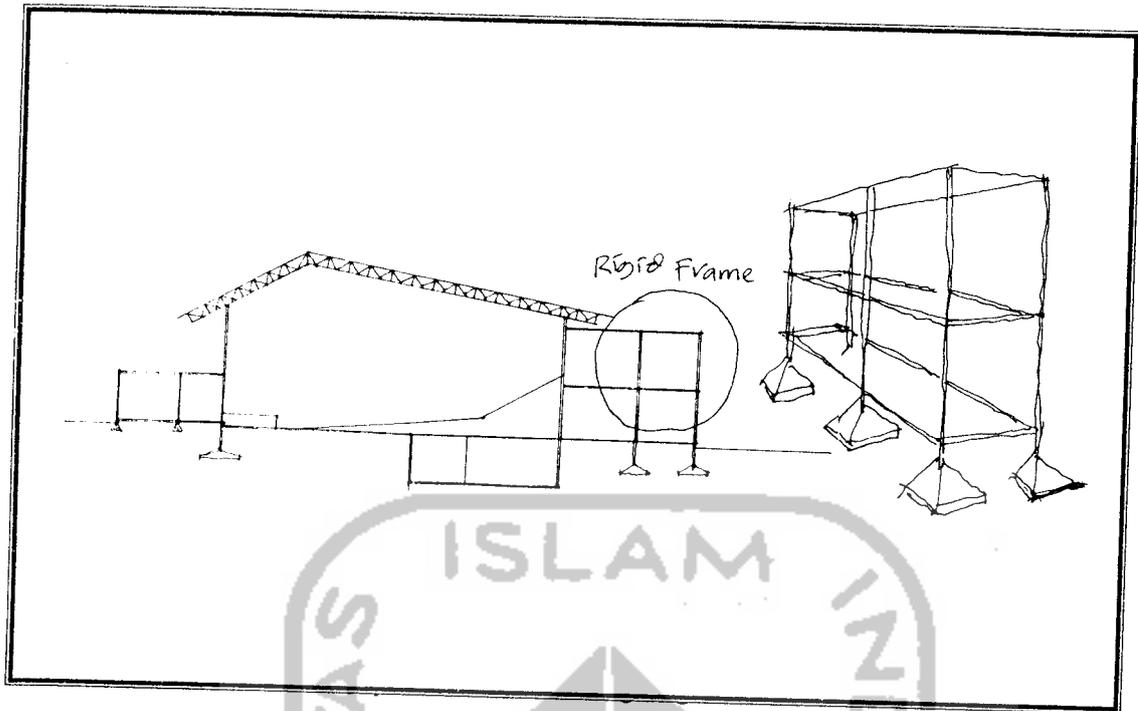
Konsep Struktural Ruang Pagelaran Seni Musik
